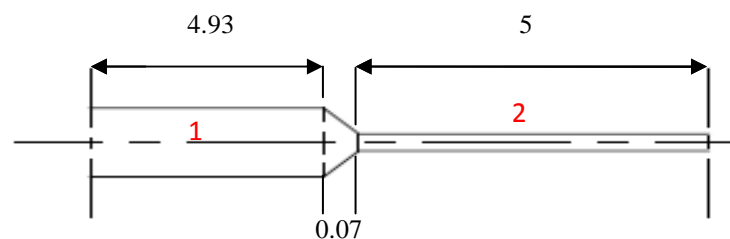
Les différentes sections qui composent la poutre en béton armé.
